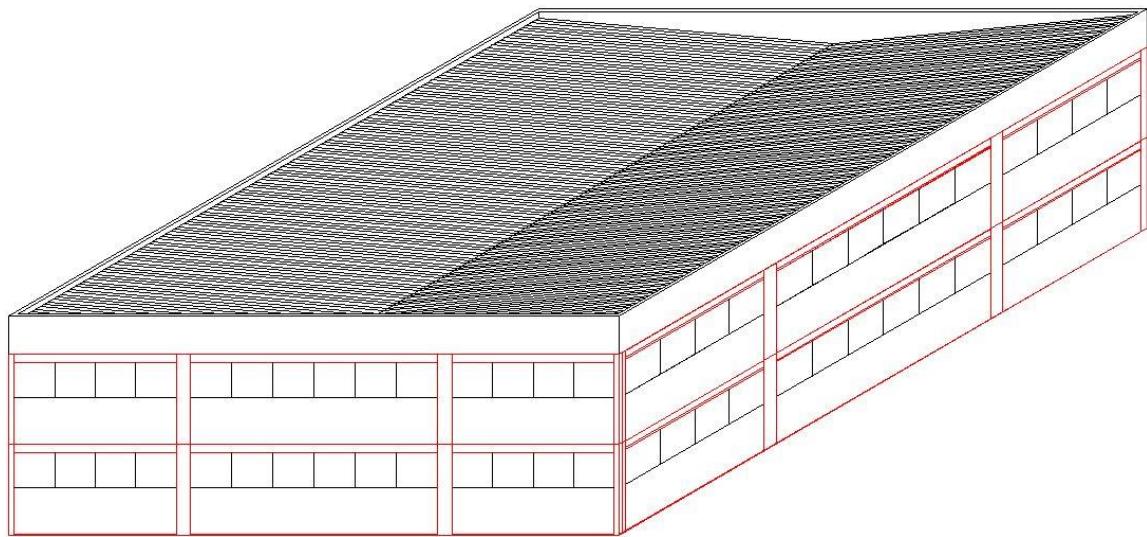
Perspectiva dos dois últimos pavimentos do edifício com estrutura adaptada em aço.
